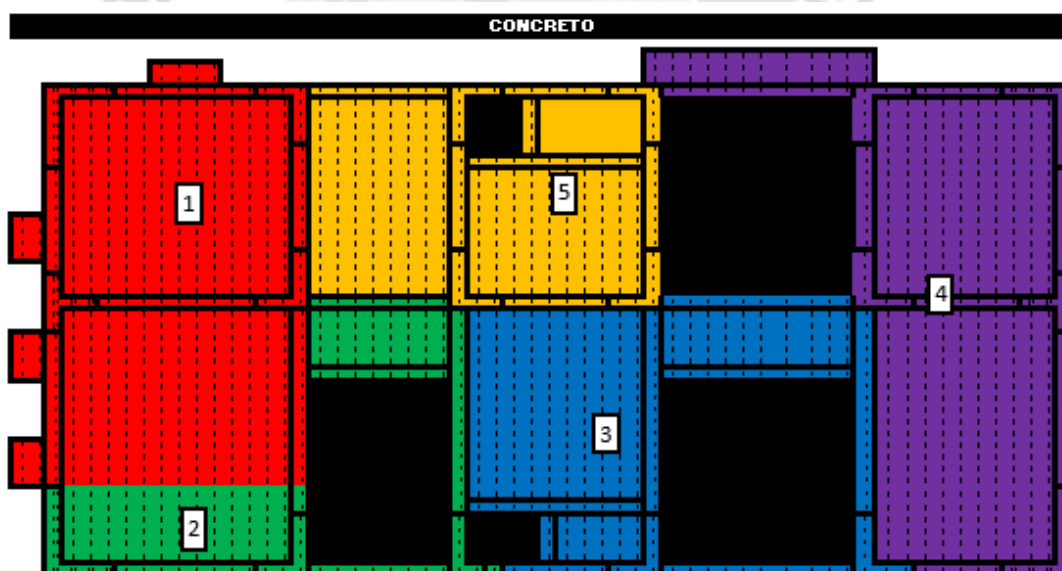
Sectorización por metrado de concreto en elementos estructurales
